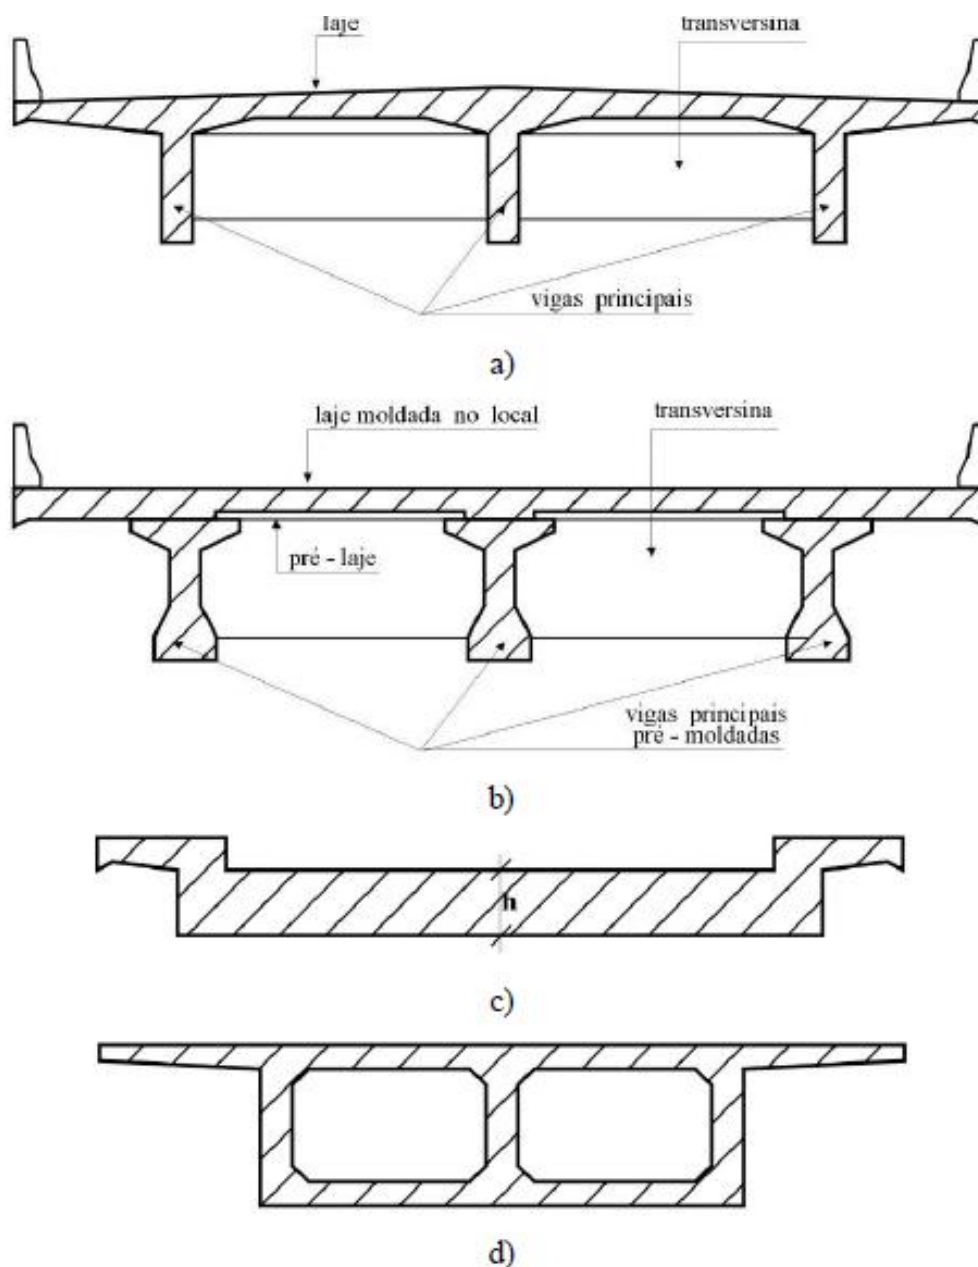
Sistemas estruturais mais frequentes: a) Vigas e lajes de concreto moldadas no local; b) Vigas pré-moldadas; c) Laje Maciça; d) Tabuleiro celular.
